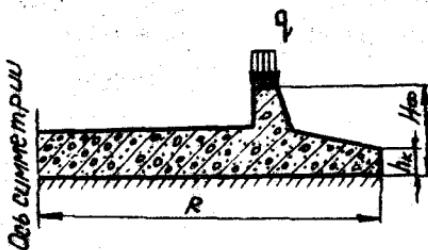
Фундамент под дымовую трубу в виде круглой плиты.
